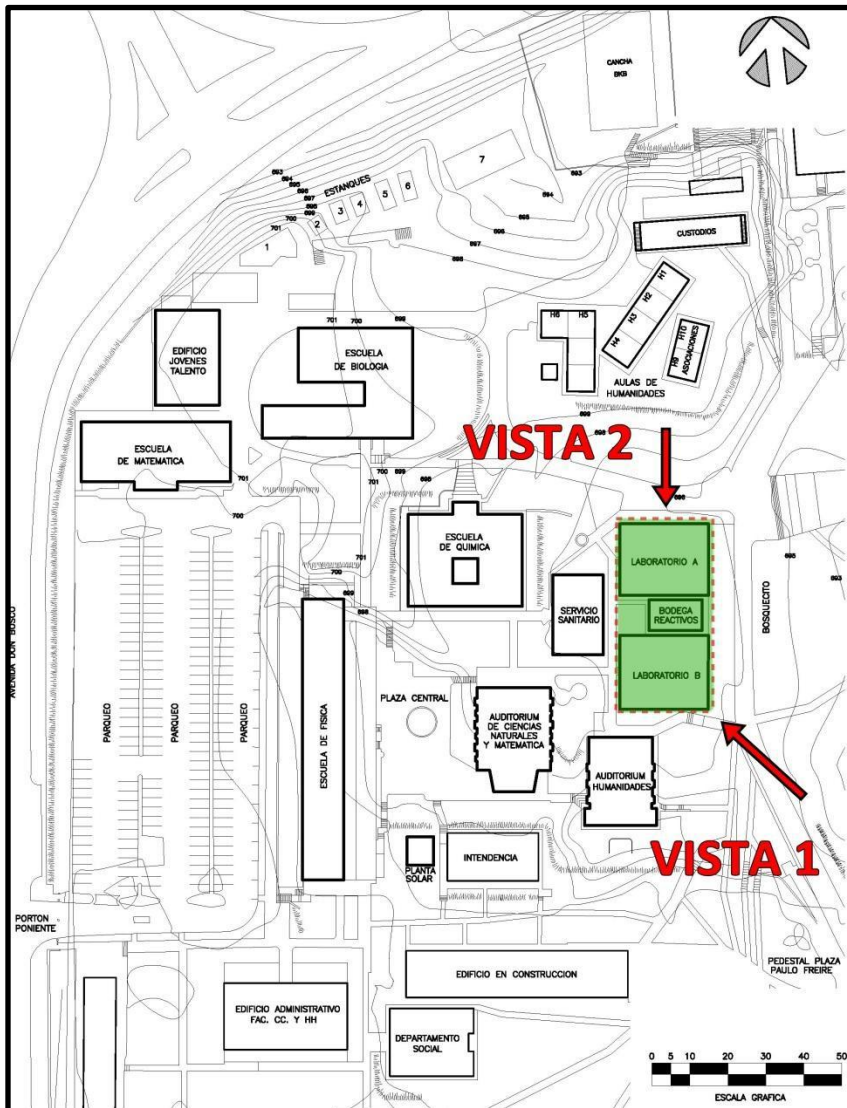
PLANO DE UBICACIÓN DE TERRENO ALTERNATIVA No. 1
